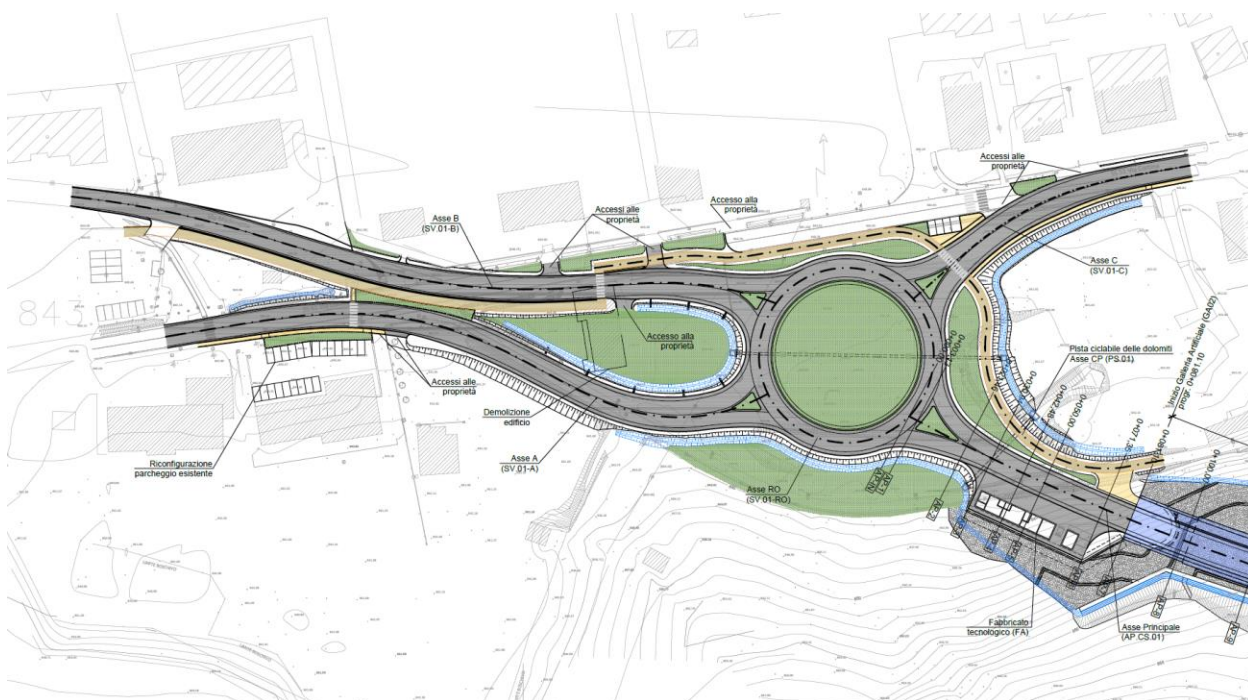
Stralcio planimetrico rotonda svincolo Ovest
